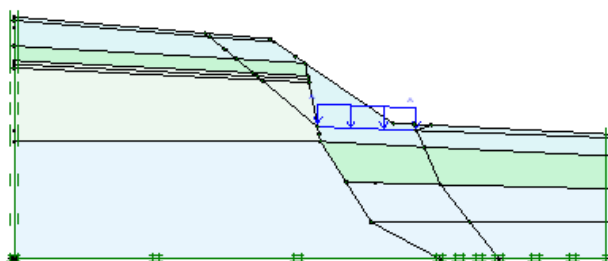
Расчетная схема выемки грунта в террасе откоса по второму варианту
